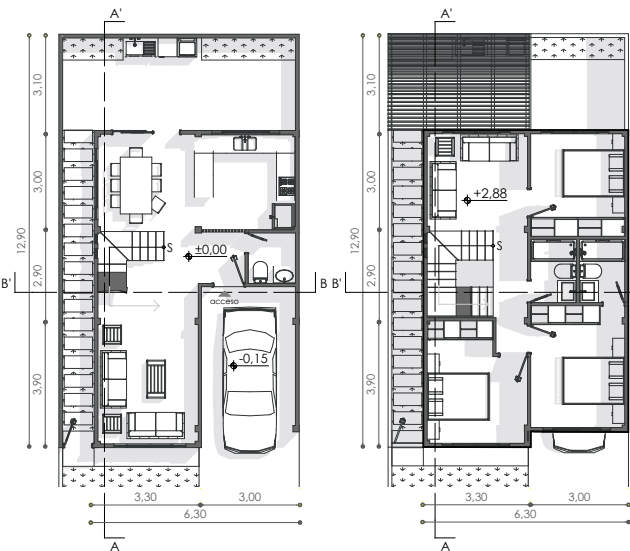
Plantas arquitectónicas remodeladas de vivienda seleccionada
